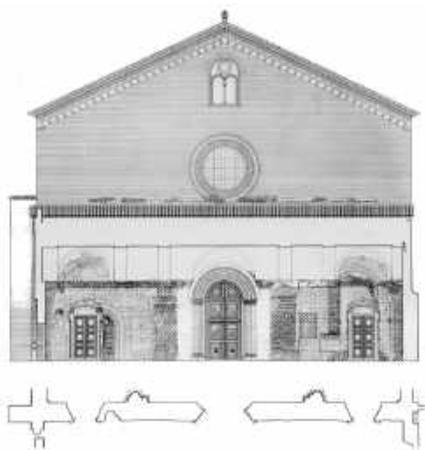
Sezione sul portico e stato di degrado delle murature
